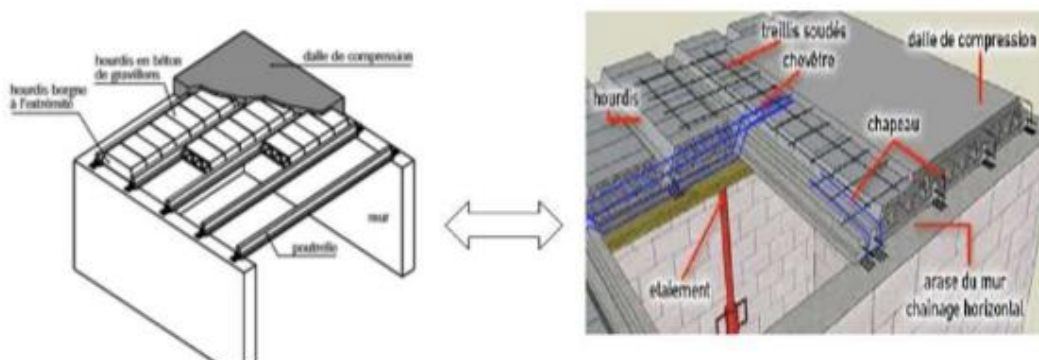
Elément d'un plancher en corps creux.
